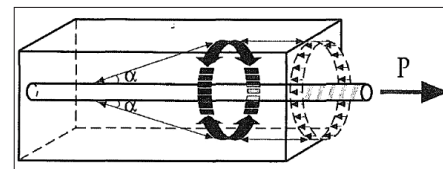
• Shematični prikaz možnega rušenja stika med rebriamo armaturno palico in betonom (1 – zdrav, 2 – mikrorazpoka, 3 – območje zdrobljenega betona).
